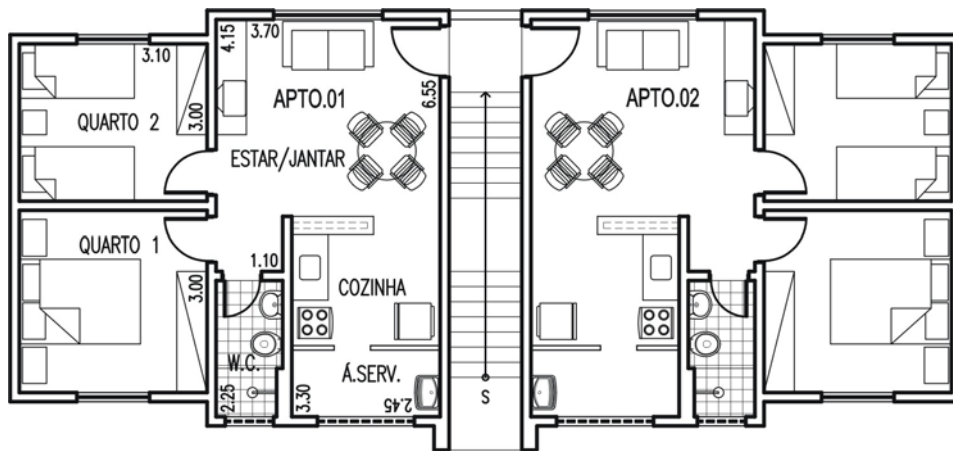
Planta baixa do pavimento tipo do Conjunto Park Maraponga
